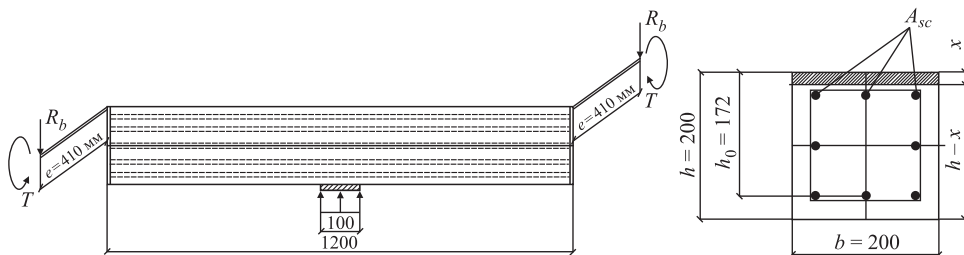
Расчетная схема нагрузок для консолей балки квадратного сечения
